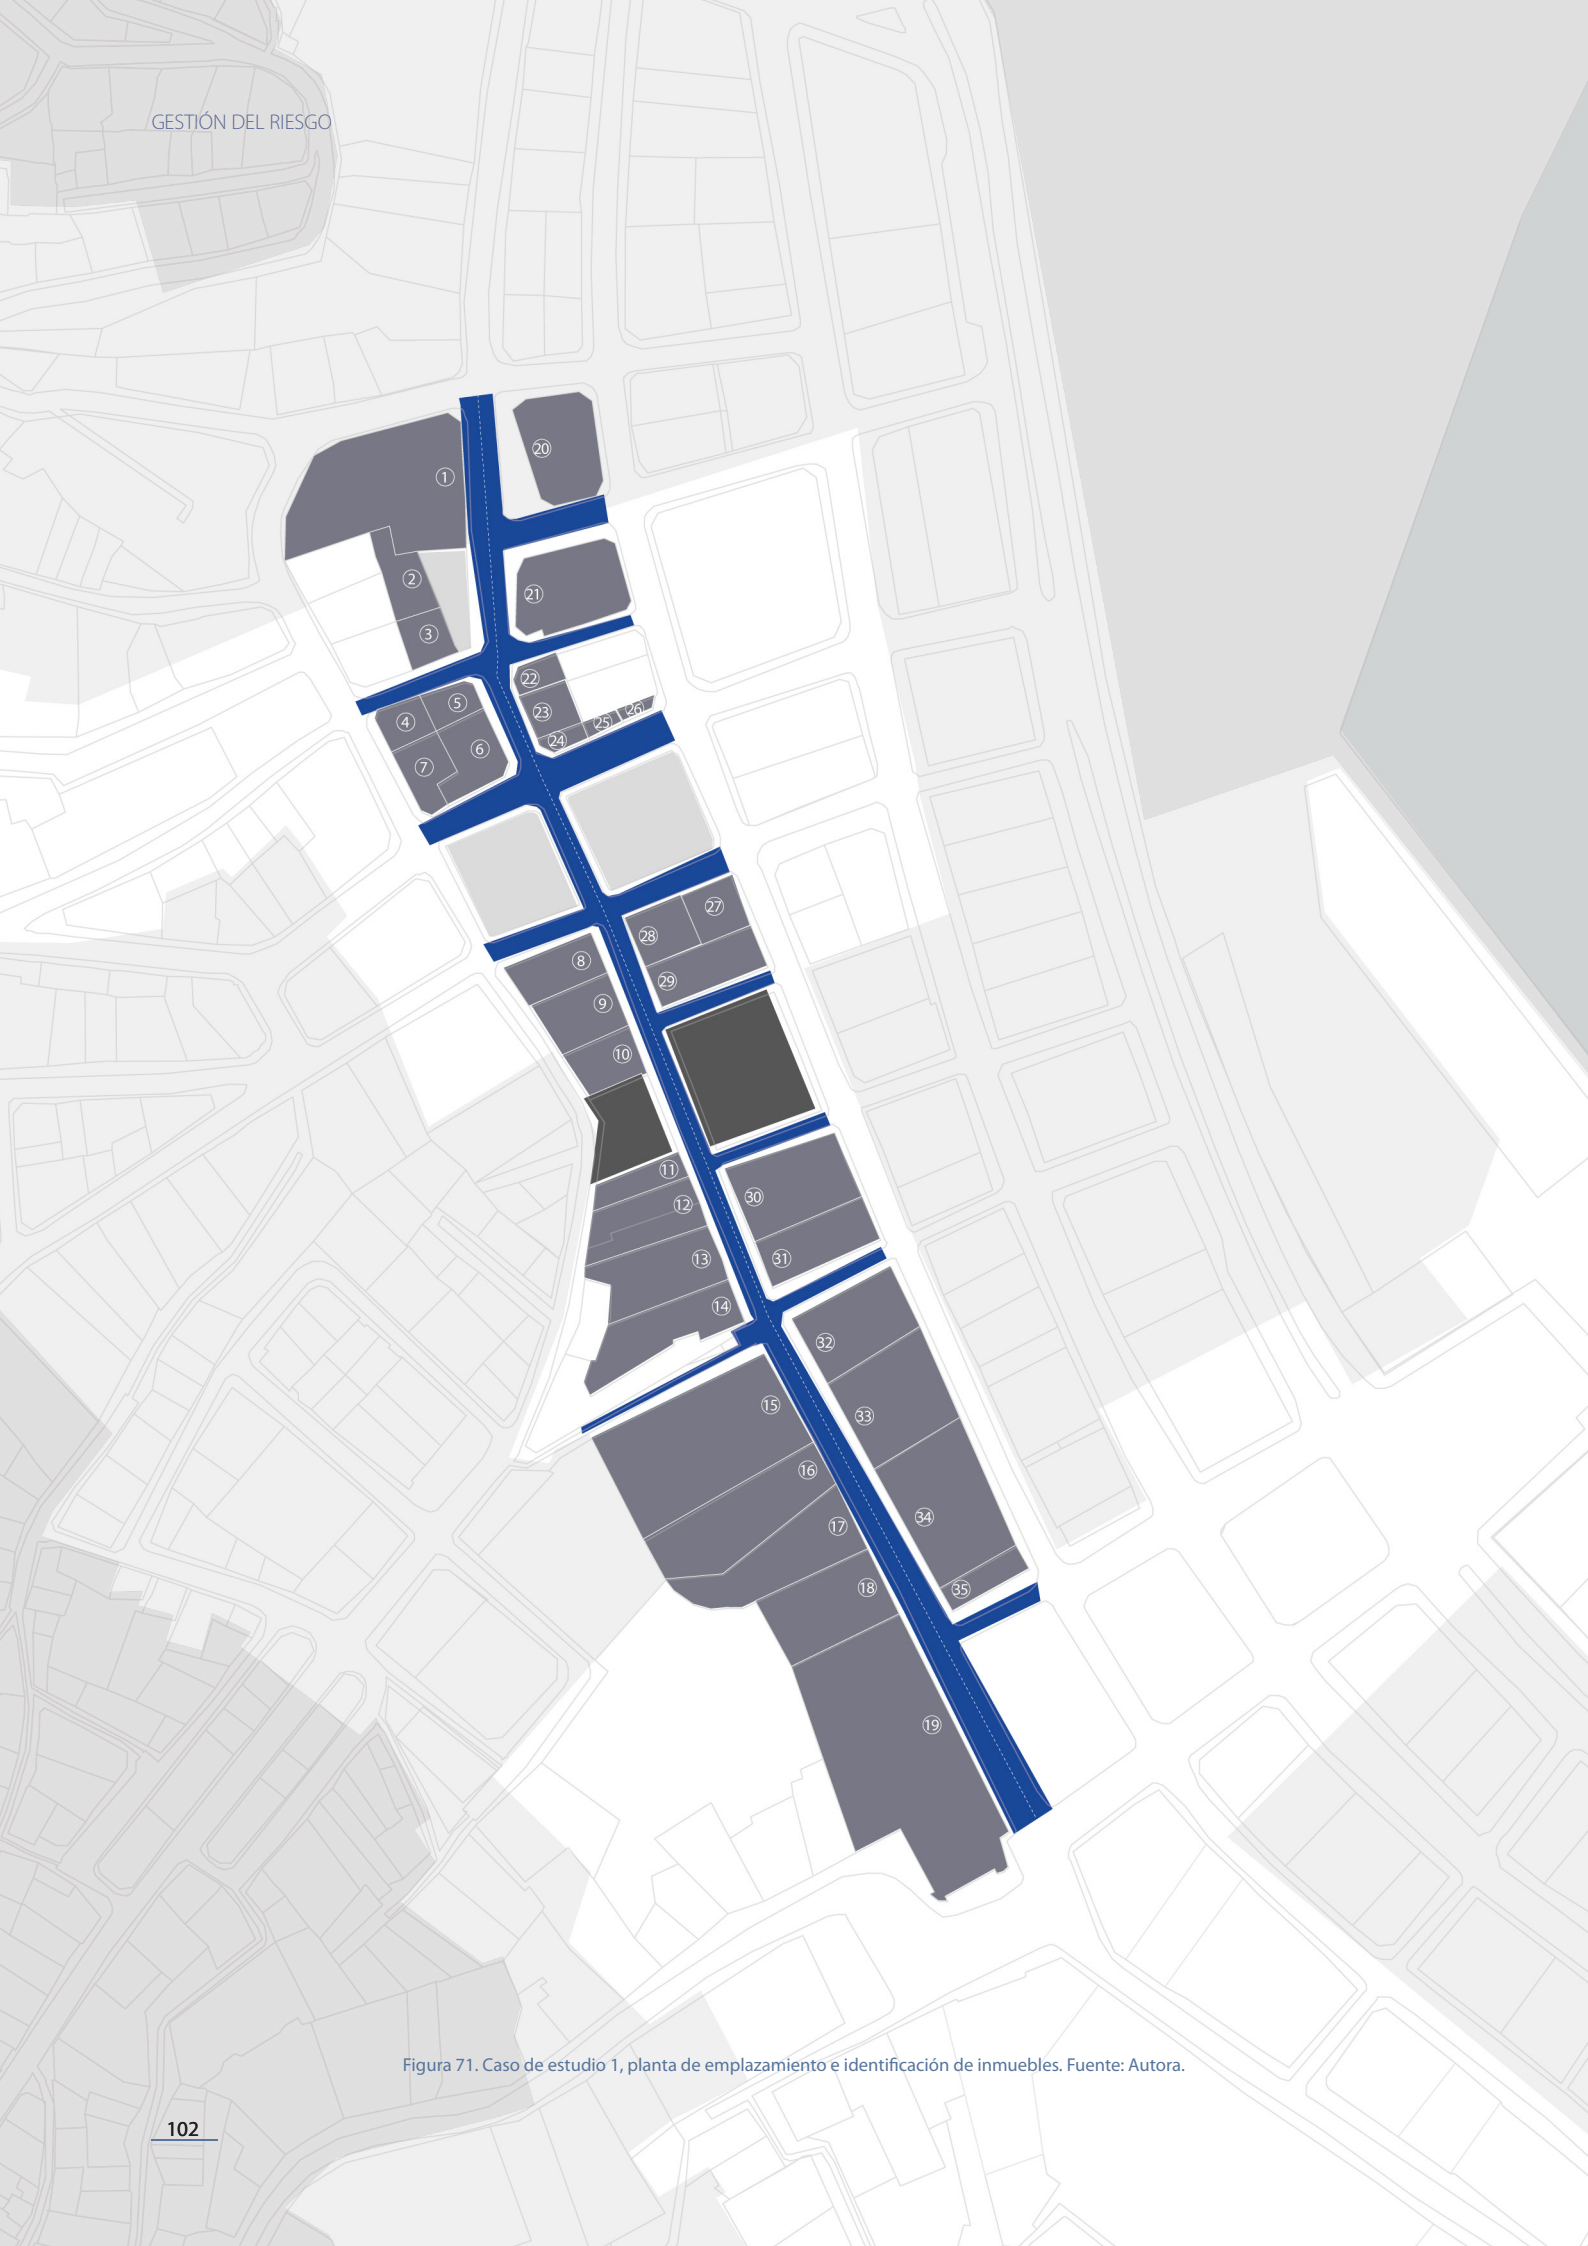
Caso de estudio 1, planta de emplazamiento e identificación de inmuebles. Fuente: Autora.
